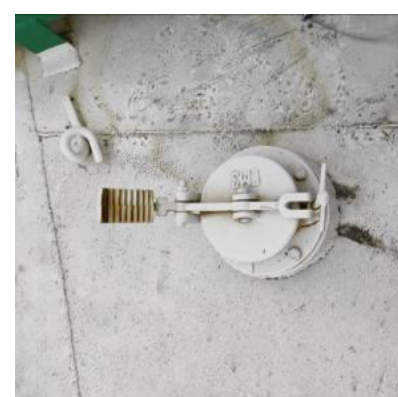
Общий вид резервуара РВС-700 (№530) с замерным люком
